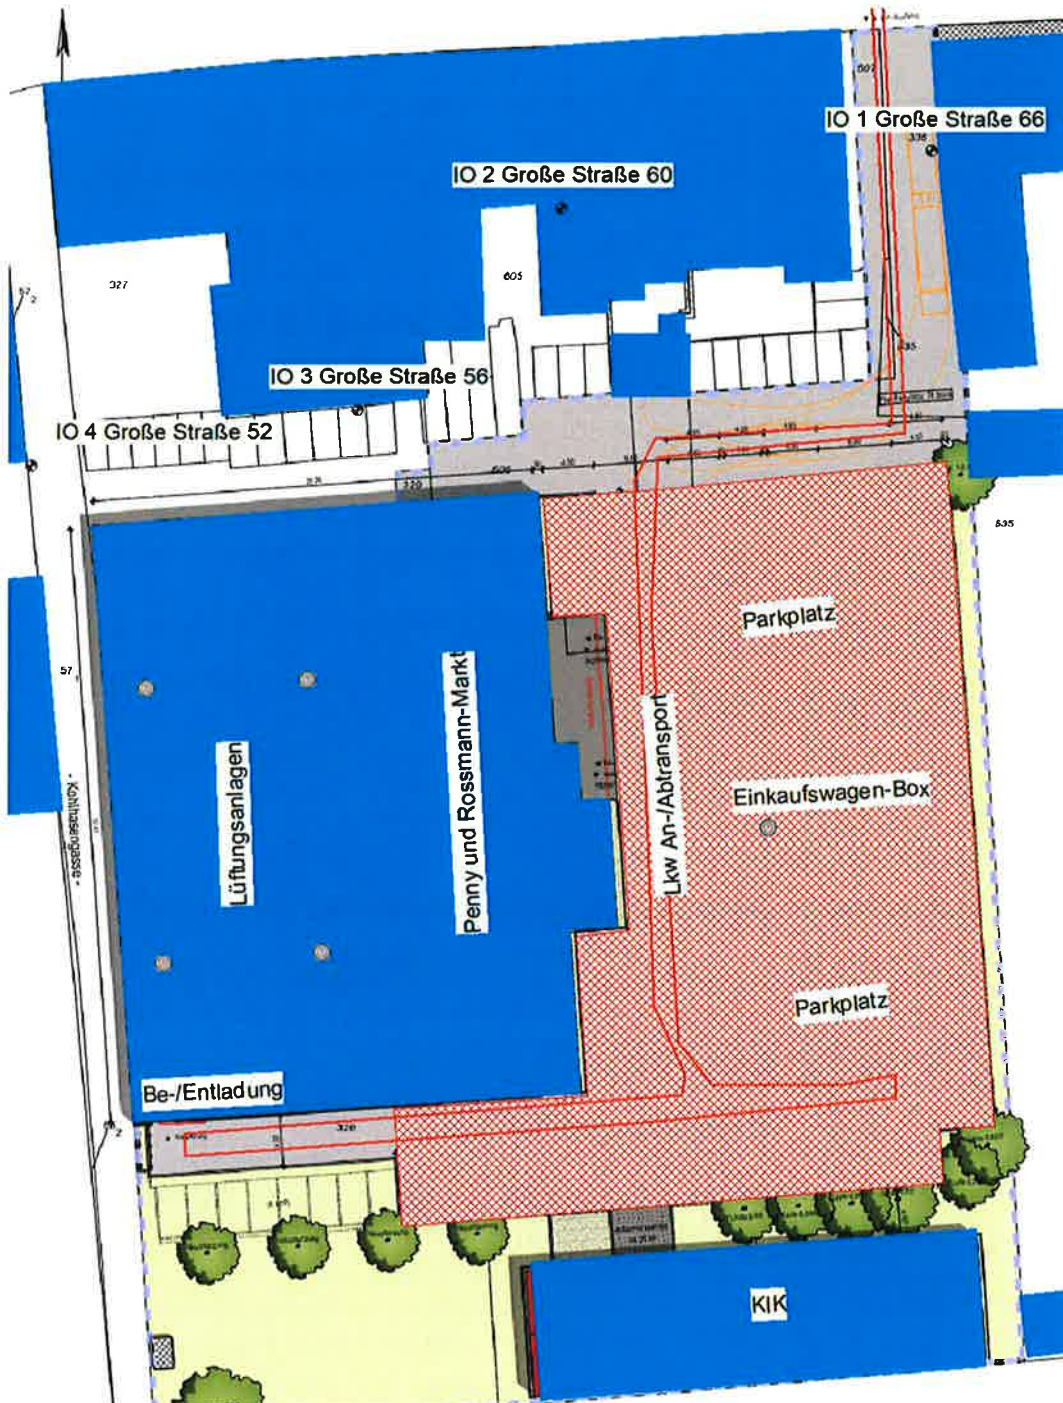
Lageplan des Neubaus mit Immissionsorten
